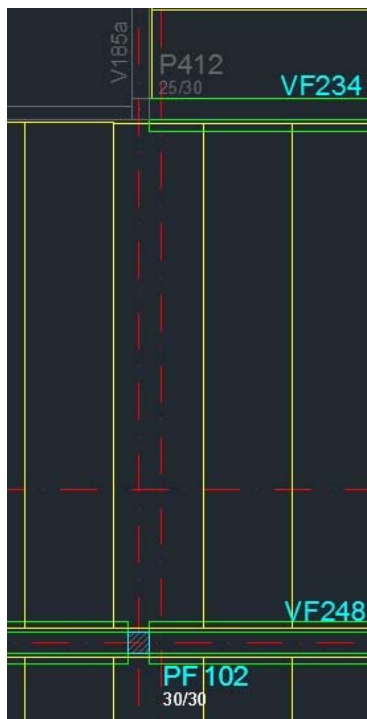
Junta de dilatação – Estrutura Pré-moldada.
